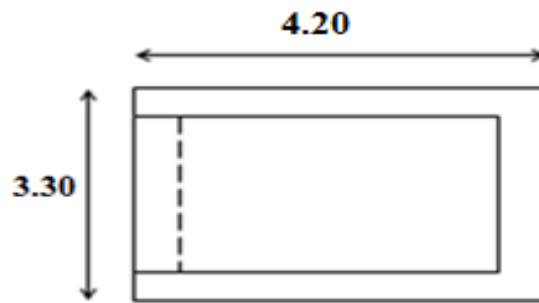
Dimensions du panneau de la dalle le plus sollicité
